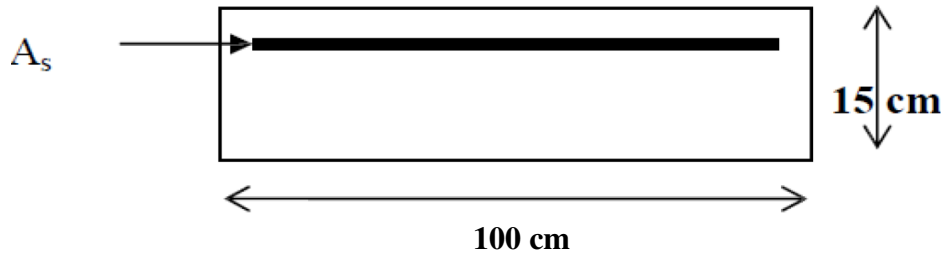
Coupe transversale d’un mètre linéaire du balcon.
